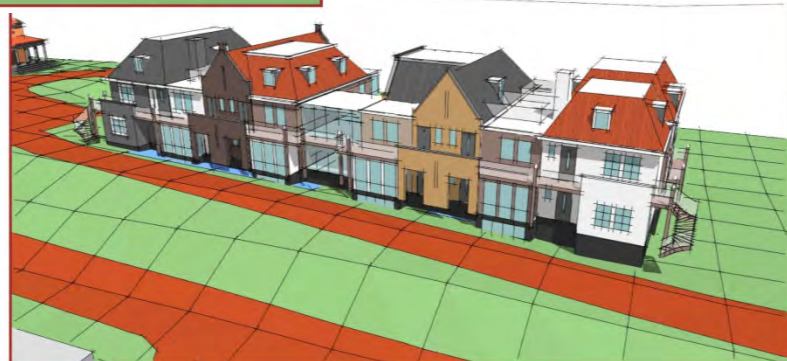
Havenplateau als centrale plek op de Verbindingsboulevard van Voorstraat naar de Haven
